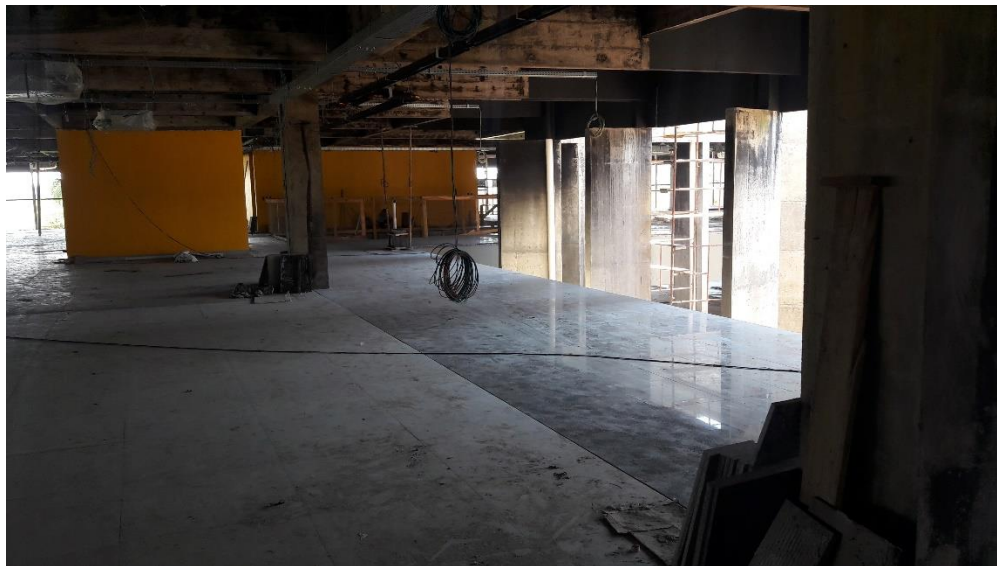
Piso assentado no segundo pavimento (Fonte: Autores)
